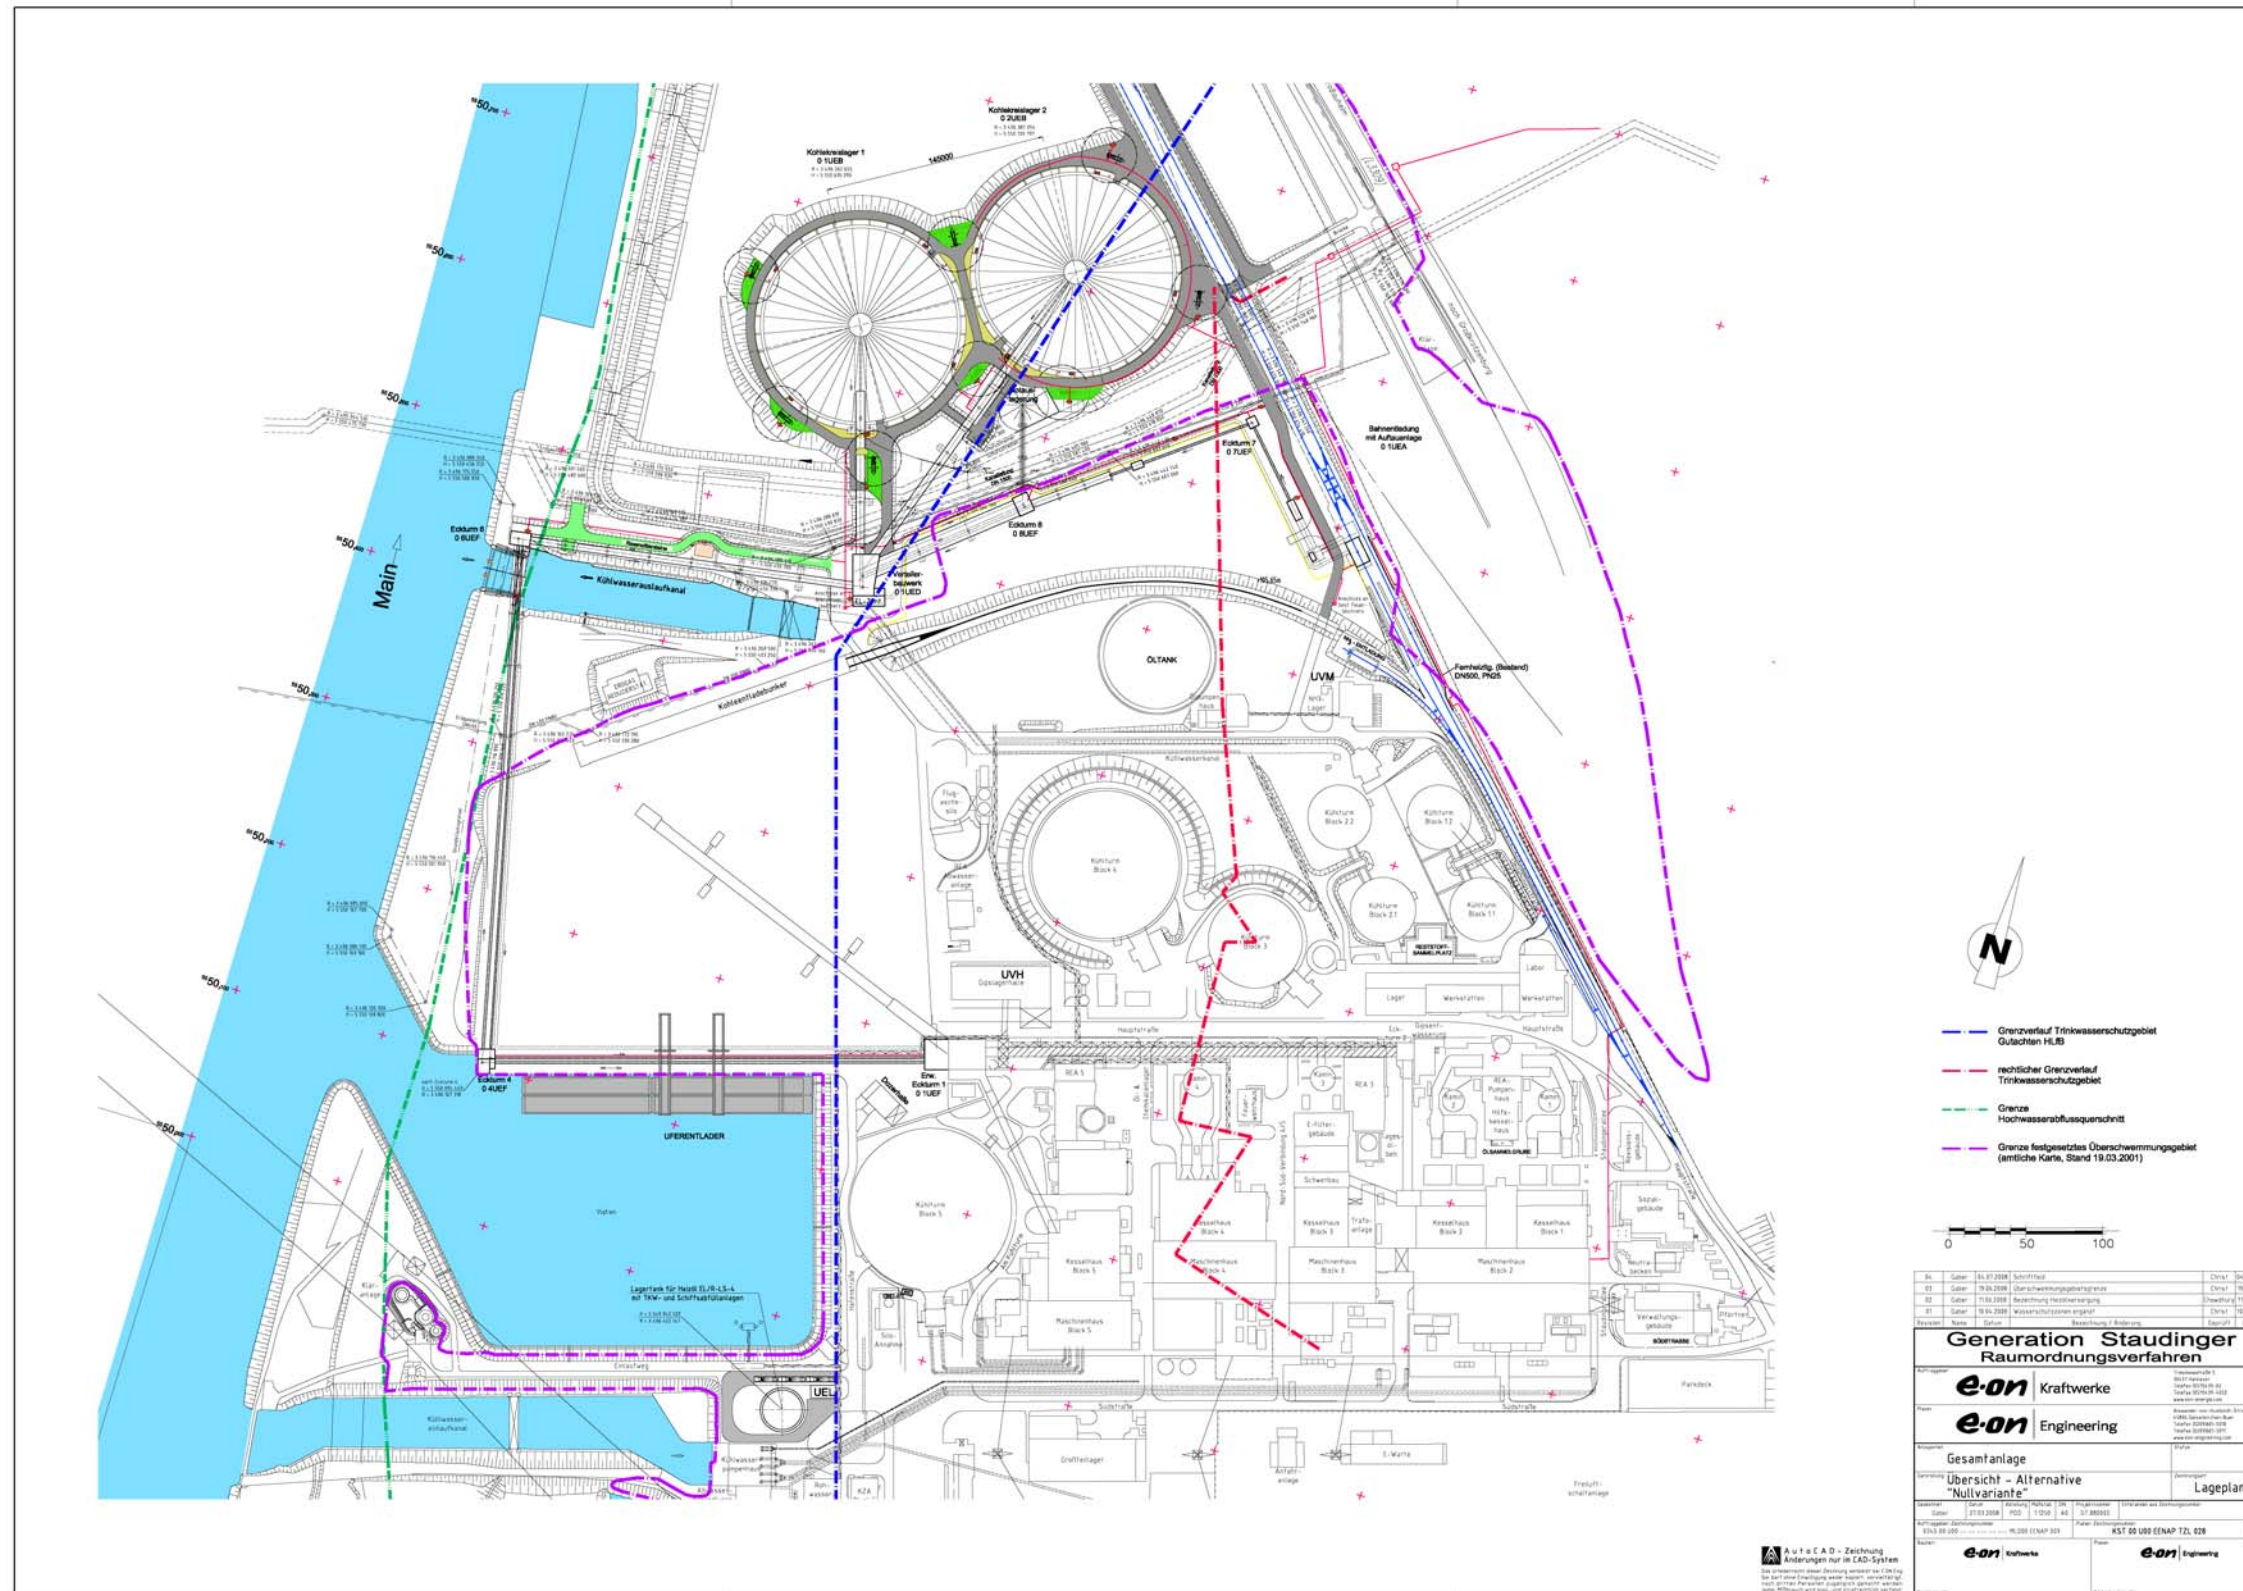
Lageplan Alternative Nullvariante (Variante C)
